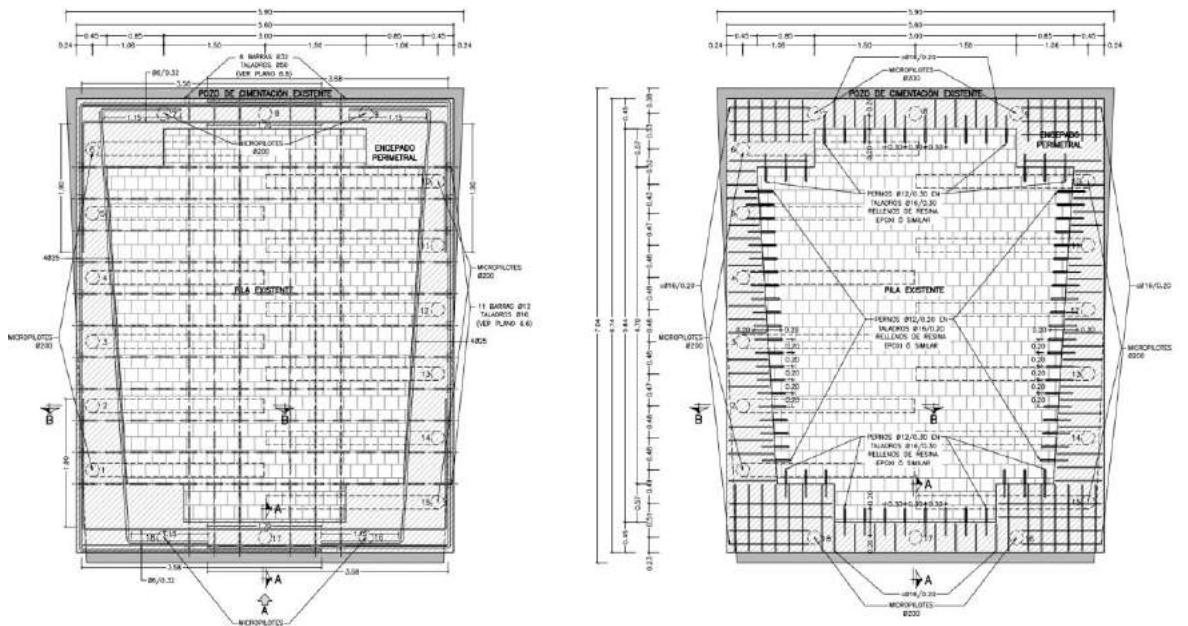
Planta con la situación de los micropilotes de las pilas P-2 y P-5, junto con el encepado perimetral
